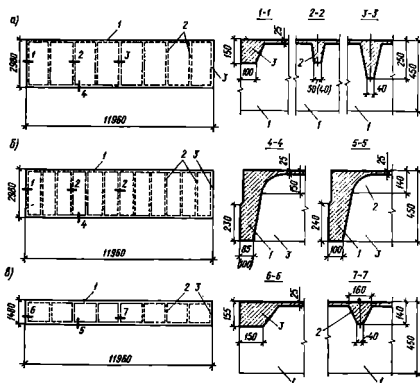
Плиты железобетонные ребристые предварительно напряженные длиной 12 м для покрытий промышленных зданий:
